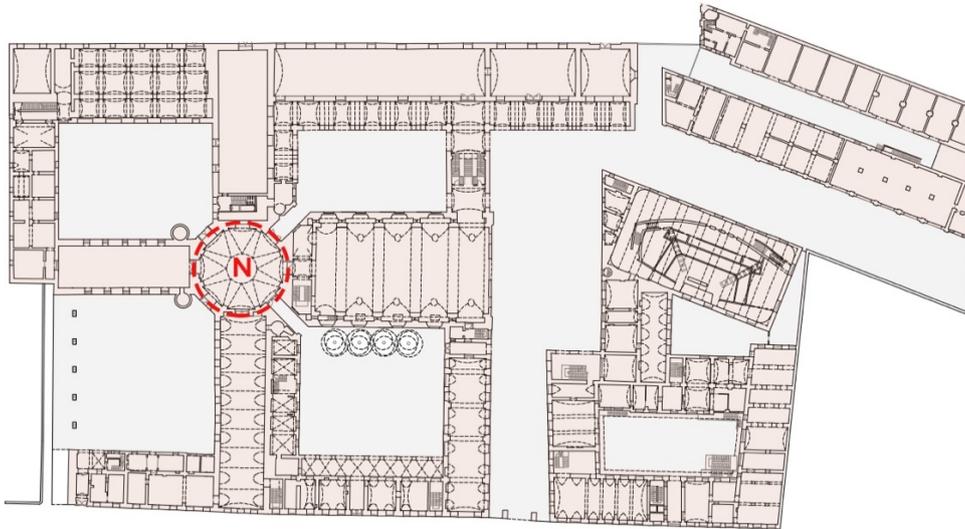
planimetria con evidenza edificio N - elaborazione personale
